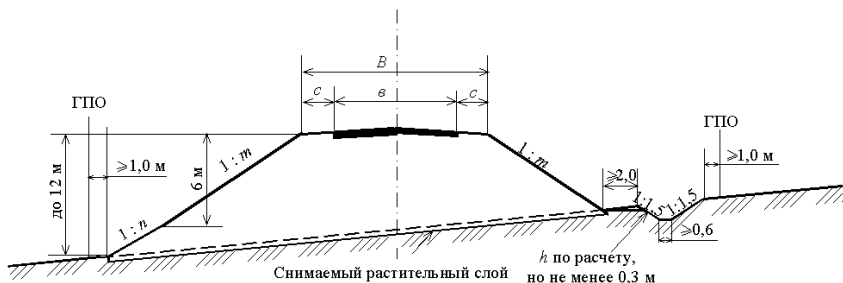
Поперечный профиль земляного полотна насыпи на косогорах с высотой откоса низовой стороны до 12 м на склонах с крутизной 1:10–1:5
